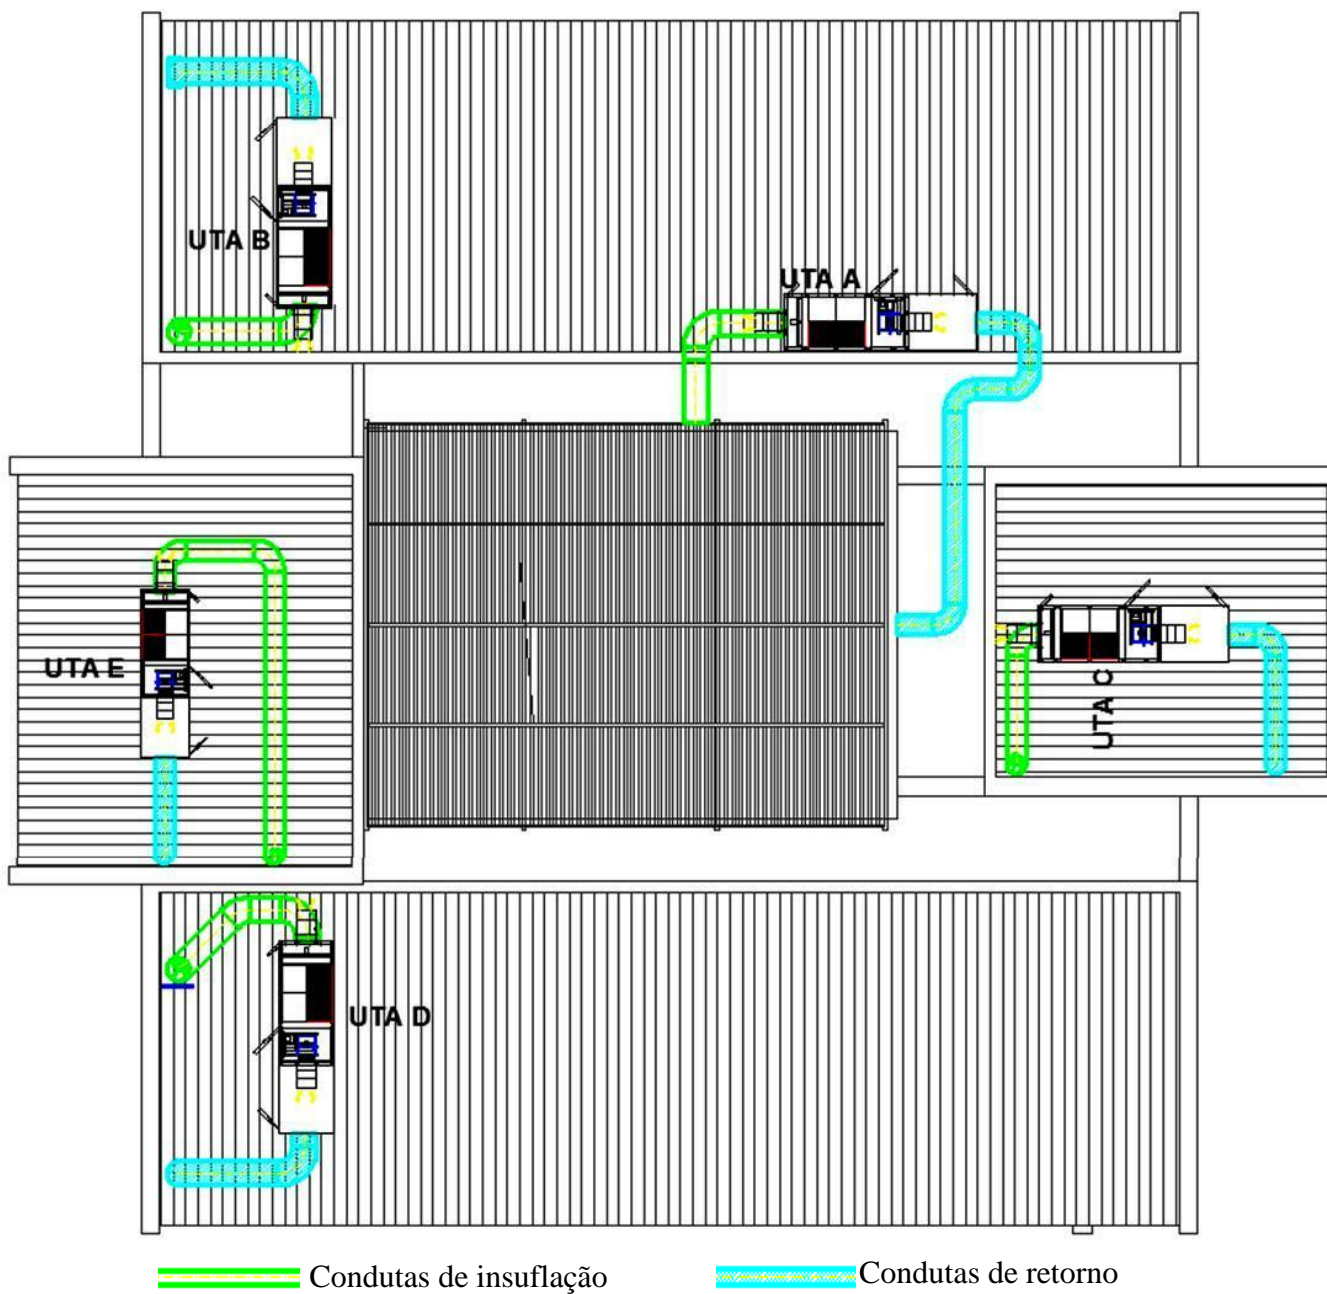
Planta do Sistema de Ventilação do Piso 1
